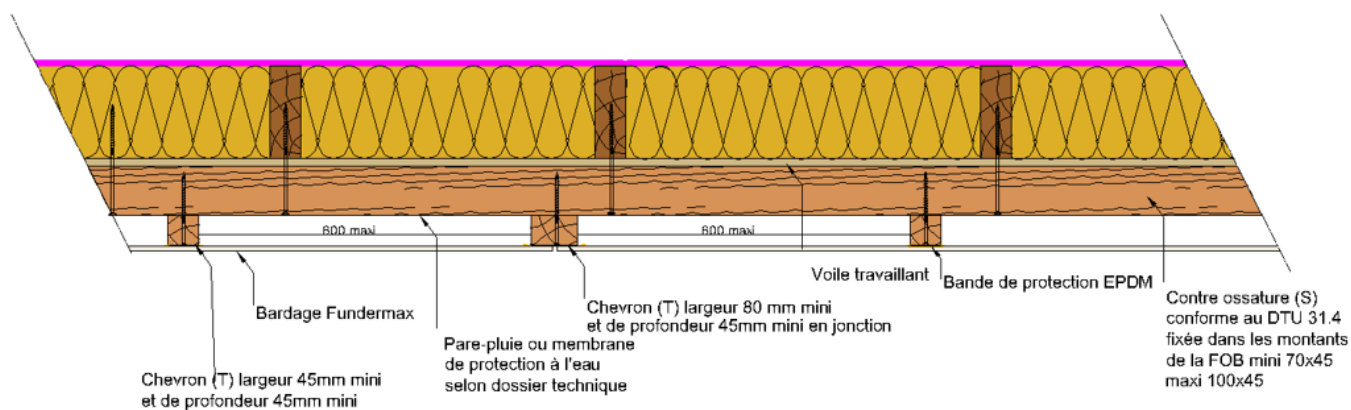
Bardage sur FOB avec contre-ossature (S), coupe horizontale
